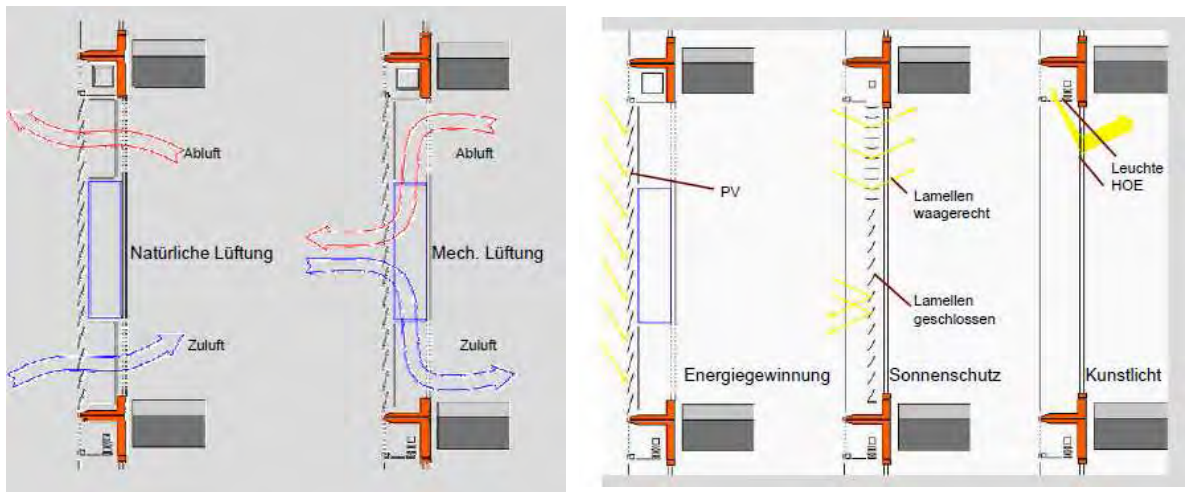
TeMotion Fassadenelement, Quelle: Müller 2008
